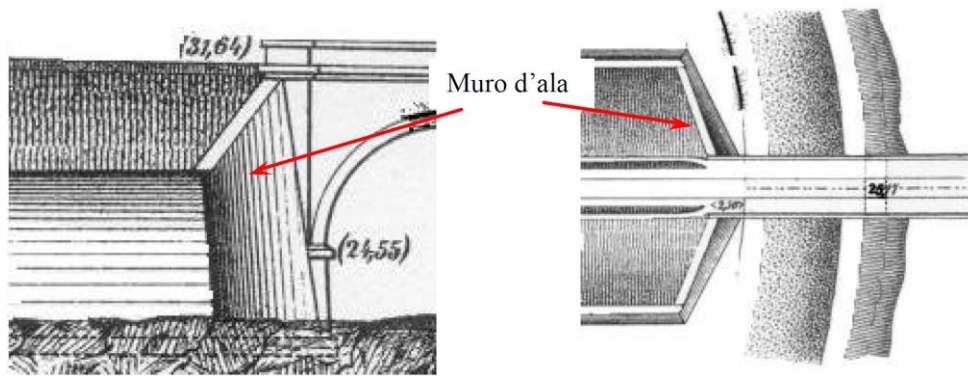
Prospetto (a sinistra) e planimetria (a destra) di un muro d'ala. [13] [8]
